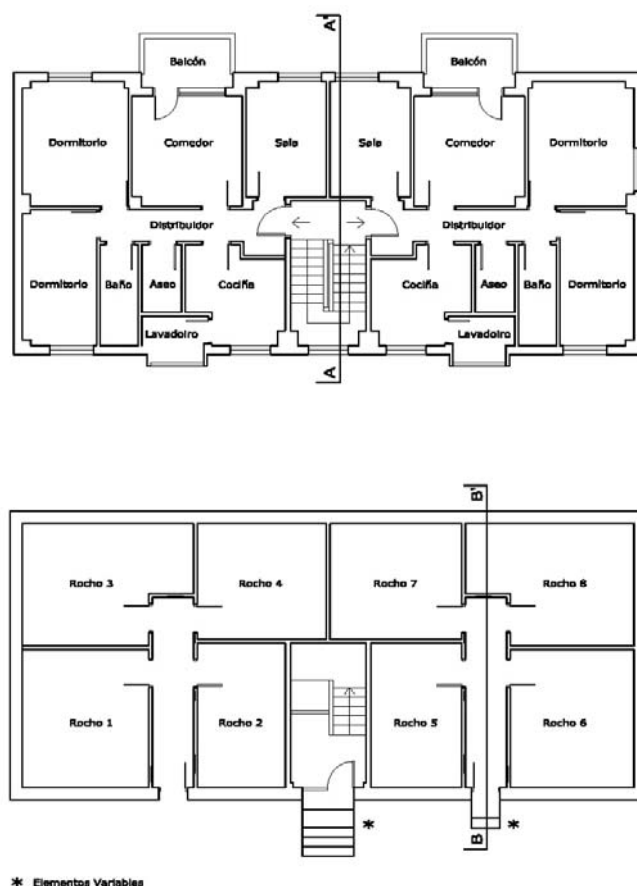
Planos de distribución de Planta Baixa e Plan Tipo e Sección da edificación.
